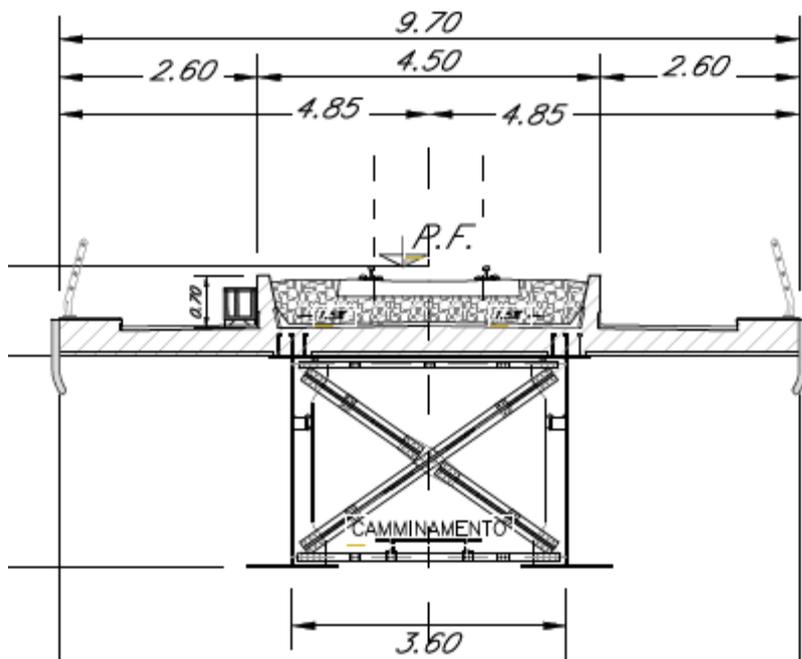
Sezione campate a sezione mista acciaio – cls (40 – 50 - 60 m) a singolo binario
